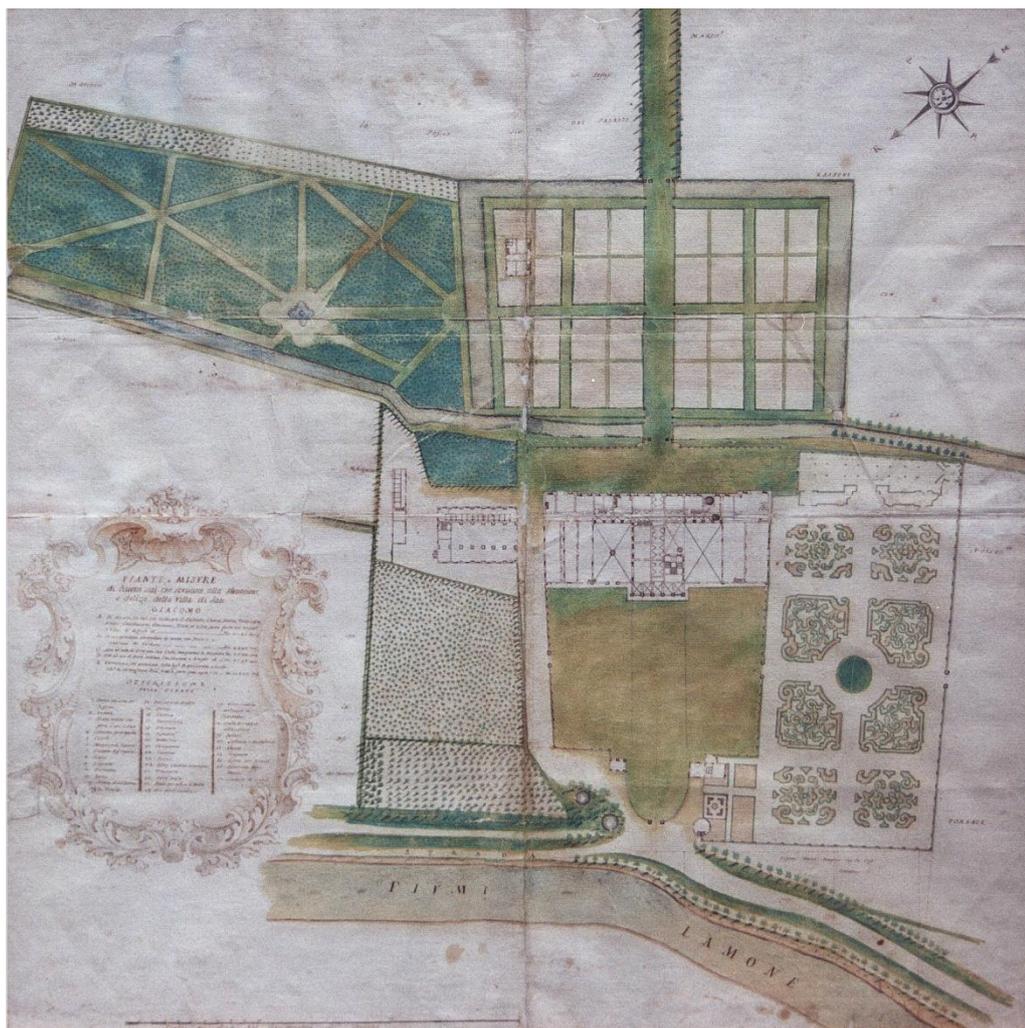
Acquerello della planimetria di San Giacomo nel 1750 ca.
